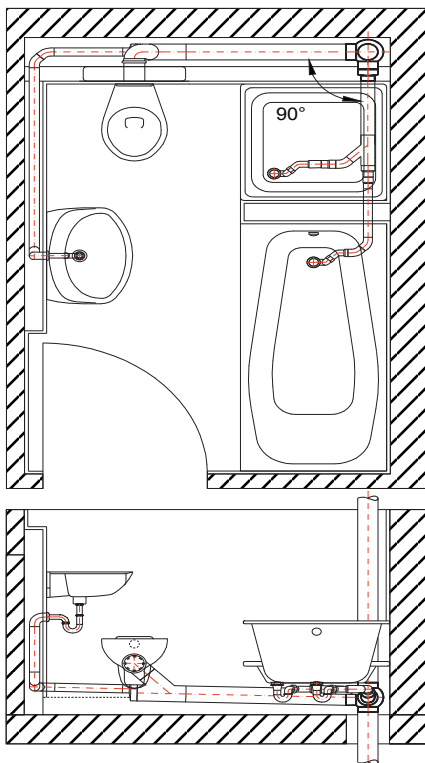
Zweieilige Installation: Überspülungs-sichere Anschlussleitungen durch Verwendung eines Kugelabzweigs
